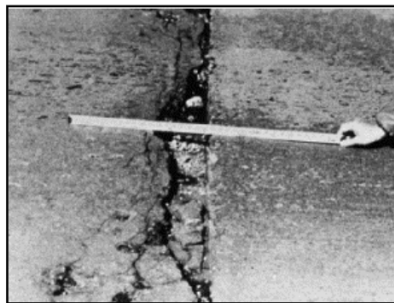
Esquema Fractura de Junta - Pavimento Rígido
